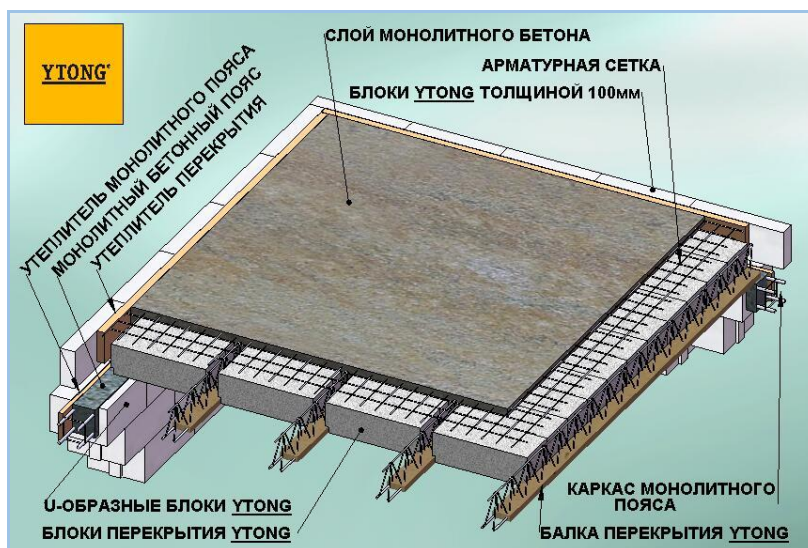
Схема сборно-монокитного перекрытия YTONG
